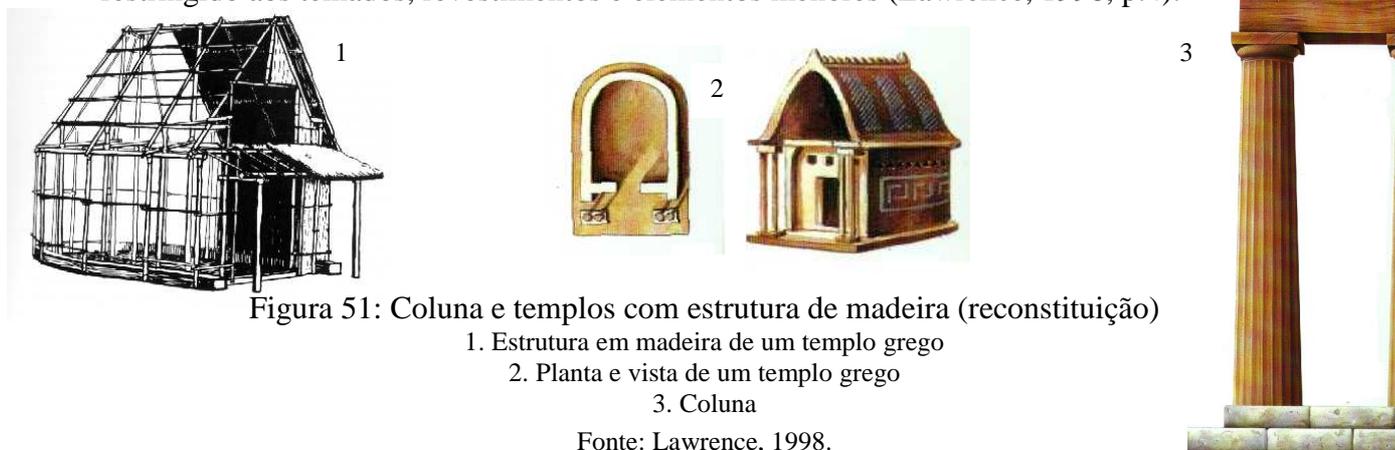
Coluna e templos com estrutura de madeira (reconstituição)
